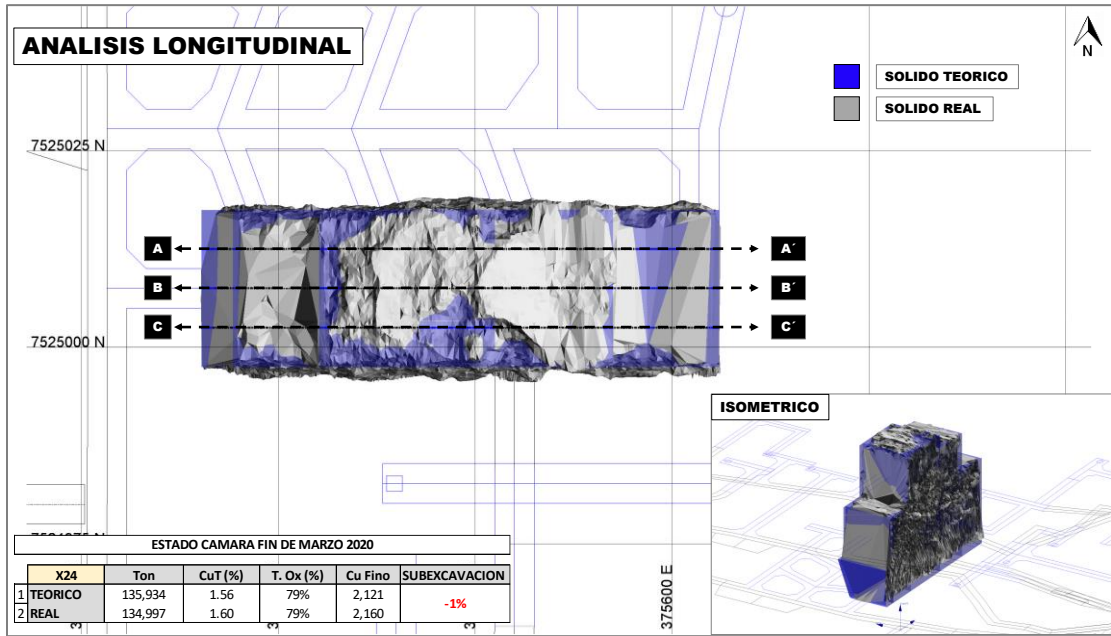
Vista planta ubicación perfiles longitudinales tipo.
